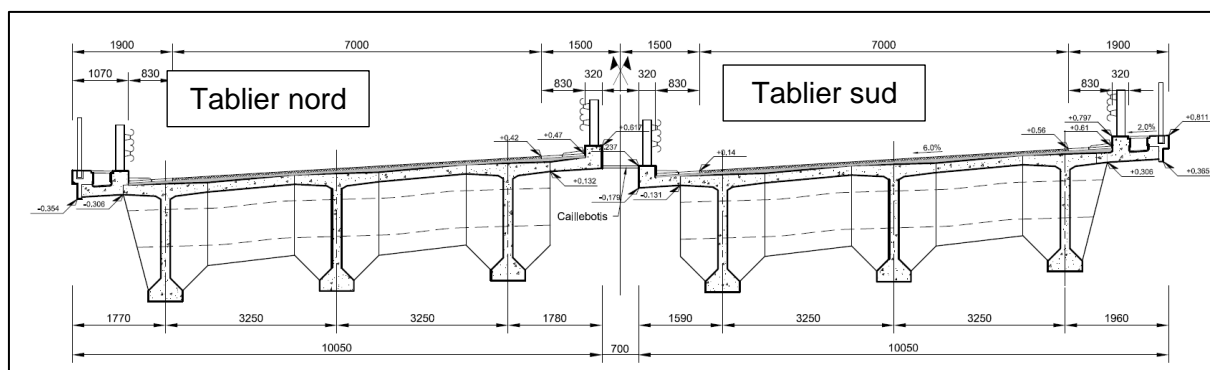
Coupe transversale des deux tabliers du viaduc avant travaux
